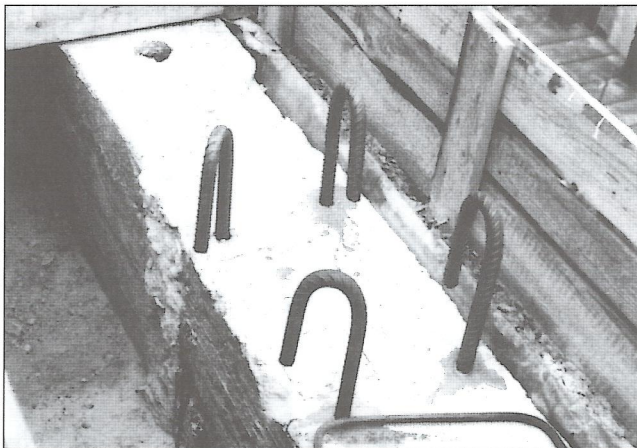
Pohled na patku sloupu S23 po betonáži (na patce je již osazena ocelová konstrukce BAUMS)
